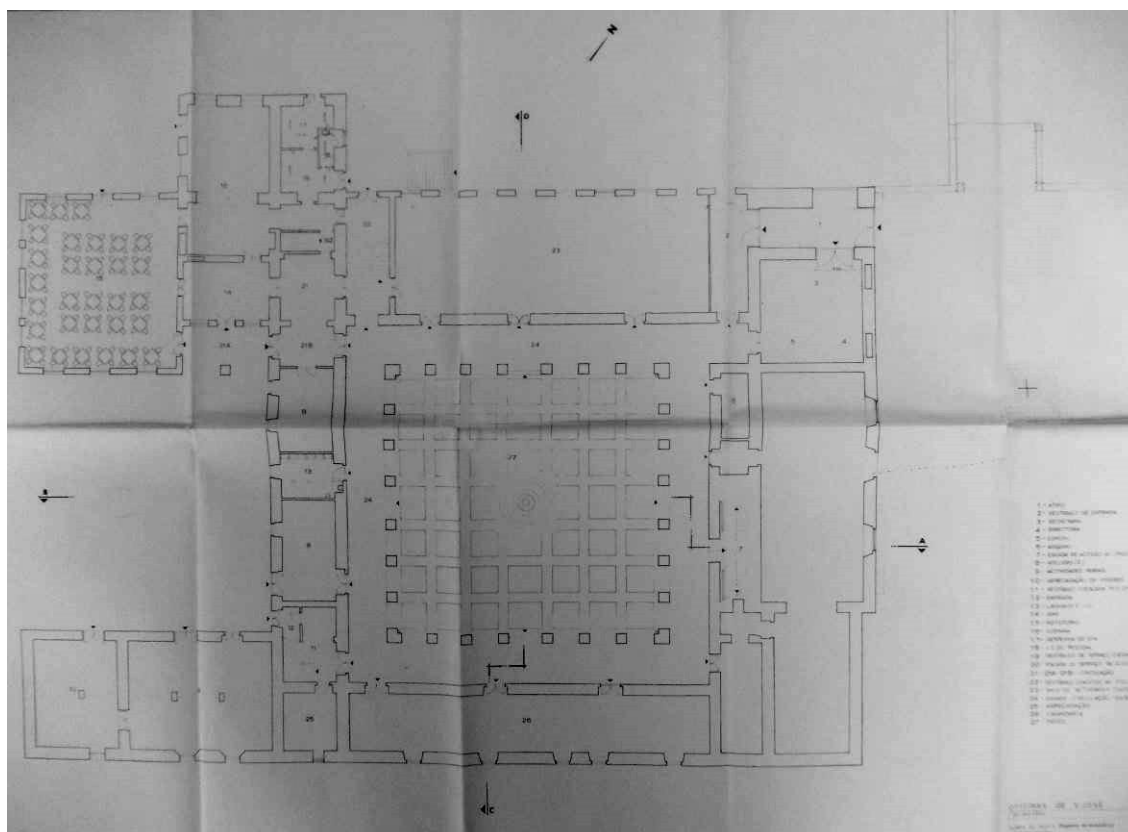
Planta de arquitetura para remodelação do edifício em 1978. (Centro Juvenil de São José).
